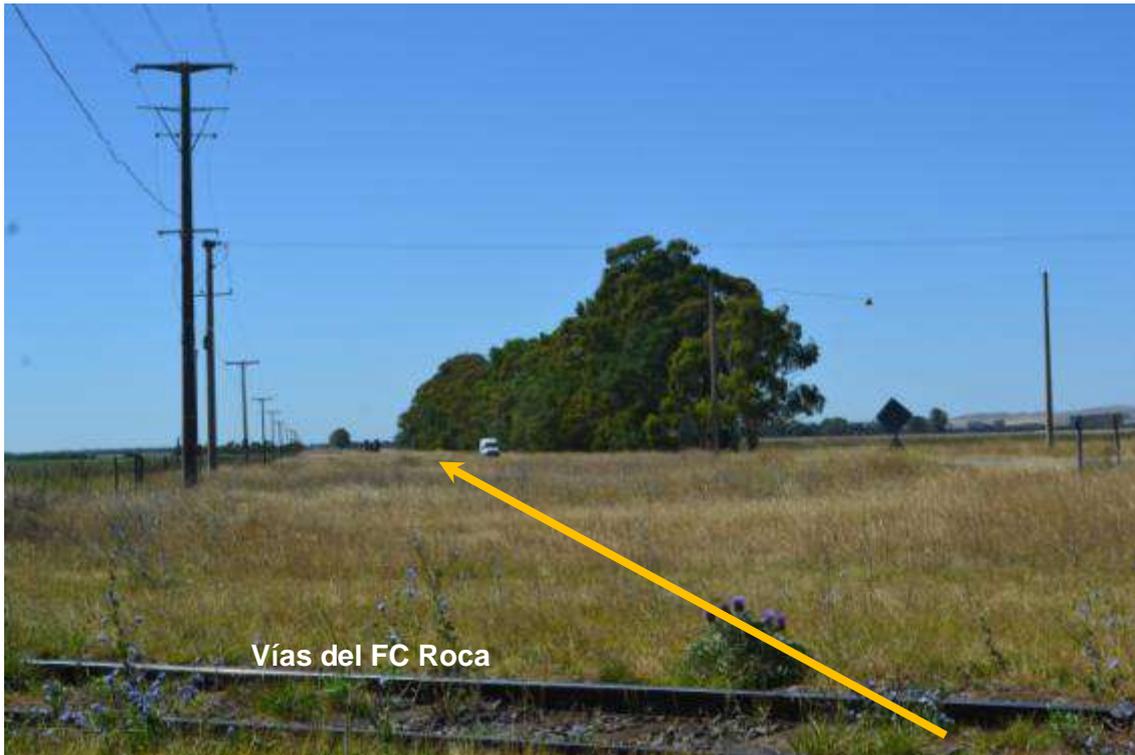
Vista al sureste desde la PK 0,04, donde se observa en detalle las vías del FC Roca que sería cruzada por la nueva cañería y la LAT 132 kV.
